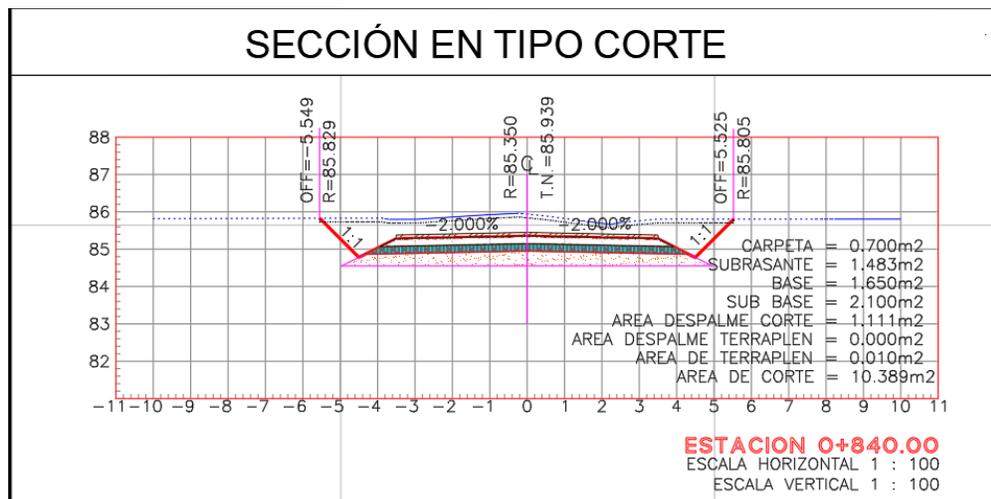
Secciones de Terreno Proyecto, con volumetría de Corte
